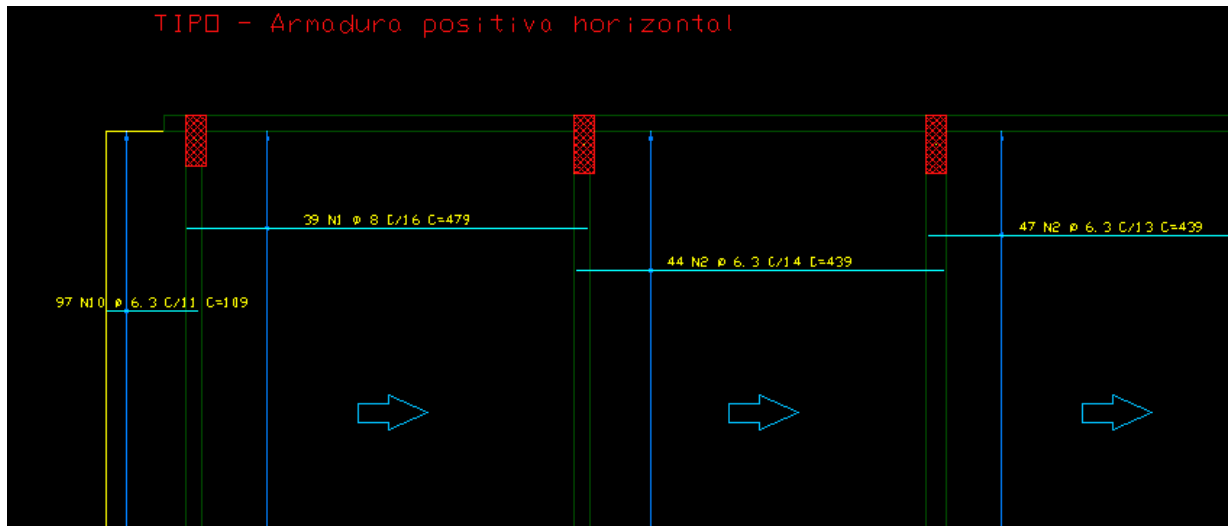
Armaduras das lajes geradas pelo TQS. (Fonte: Autor, 2023)
